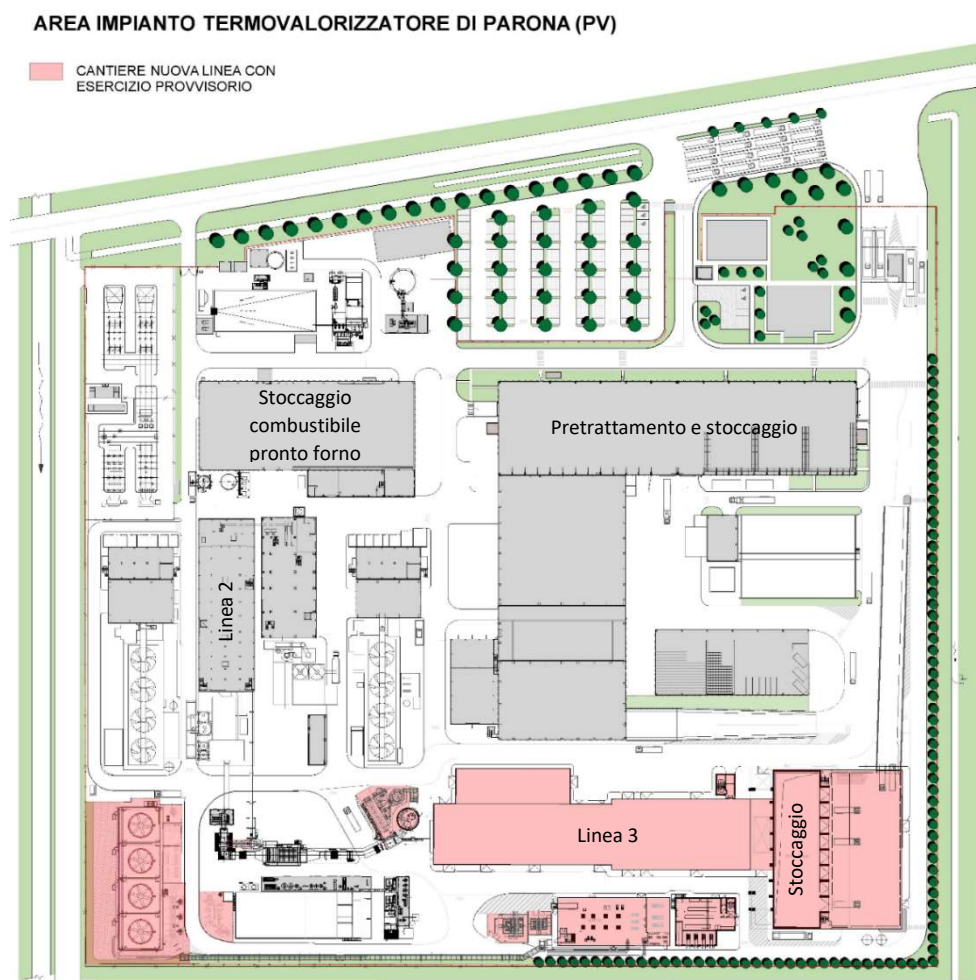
PLANIMETRIA GENERALE DELLO STABILIMENTO
